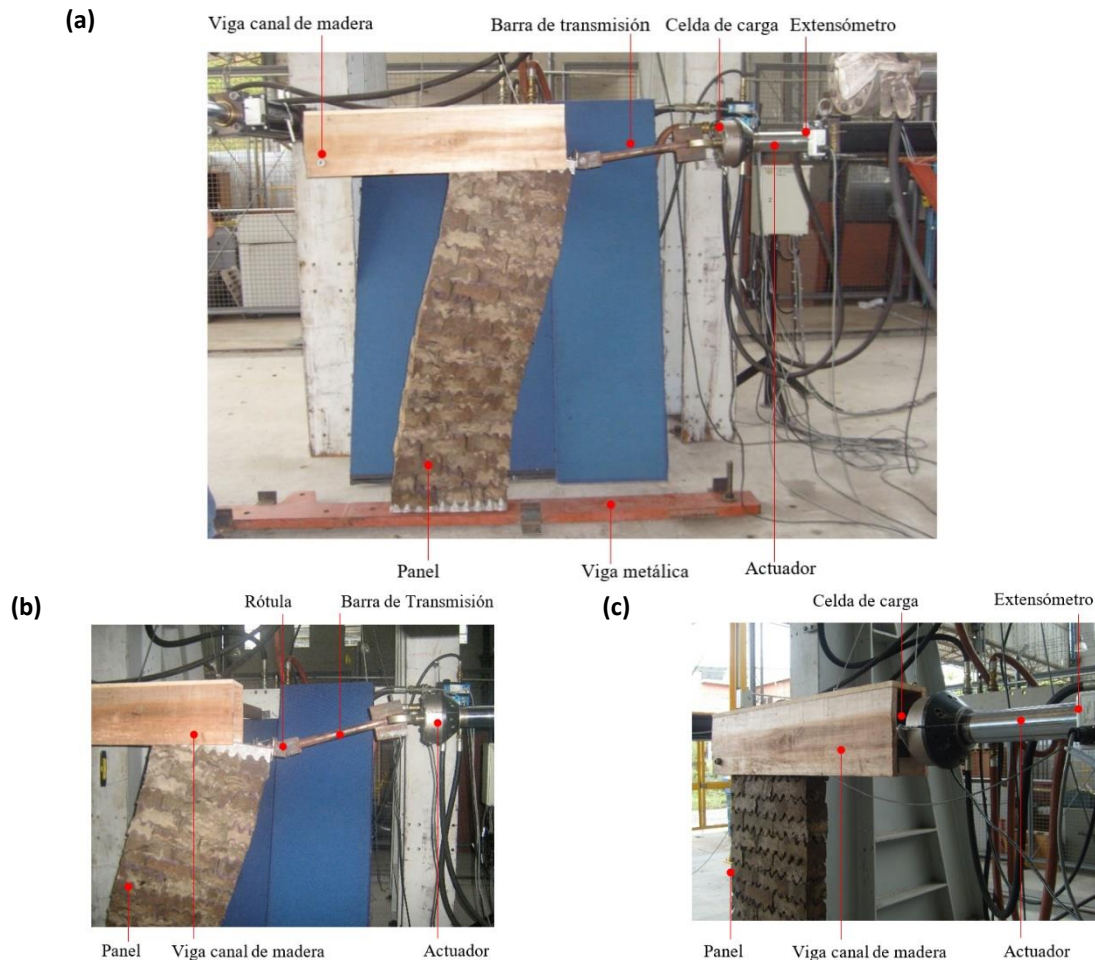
Montaje del ensayo del panel. (a) Vista frontal del montaje del ensayo del panel. (b) Unión rótula panel-actuador y (c) Actuador, celda de carga y extensómetro.
